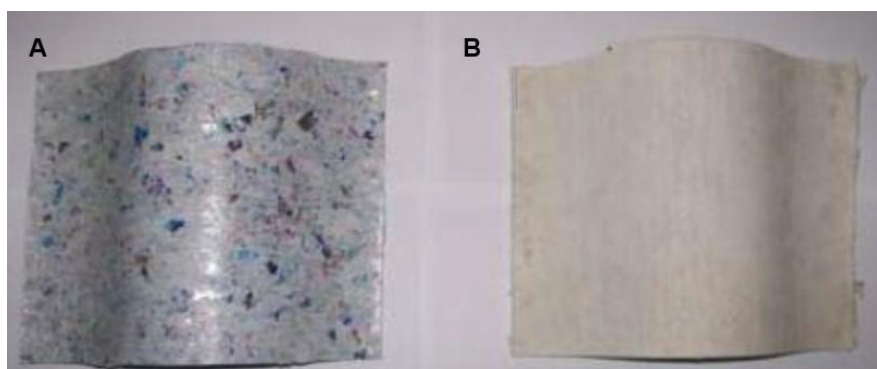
Diferentes tipos de telhas. A) telha ecológica; B) telha de fibrocimento. Fonte: Adaptado de Araújo (2018).
